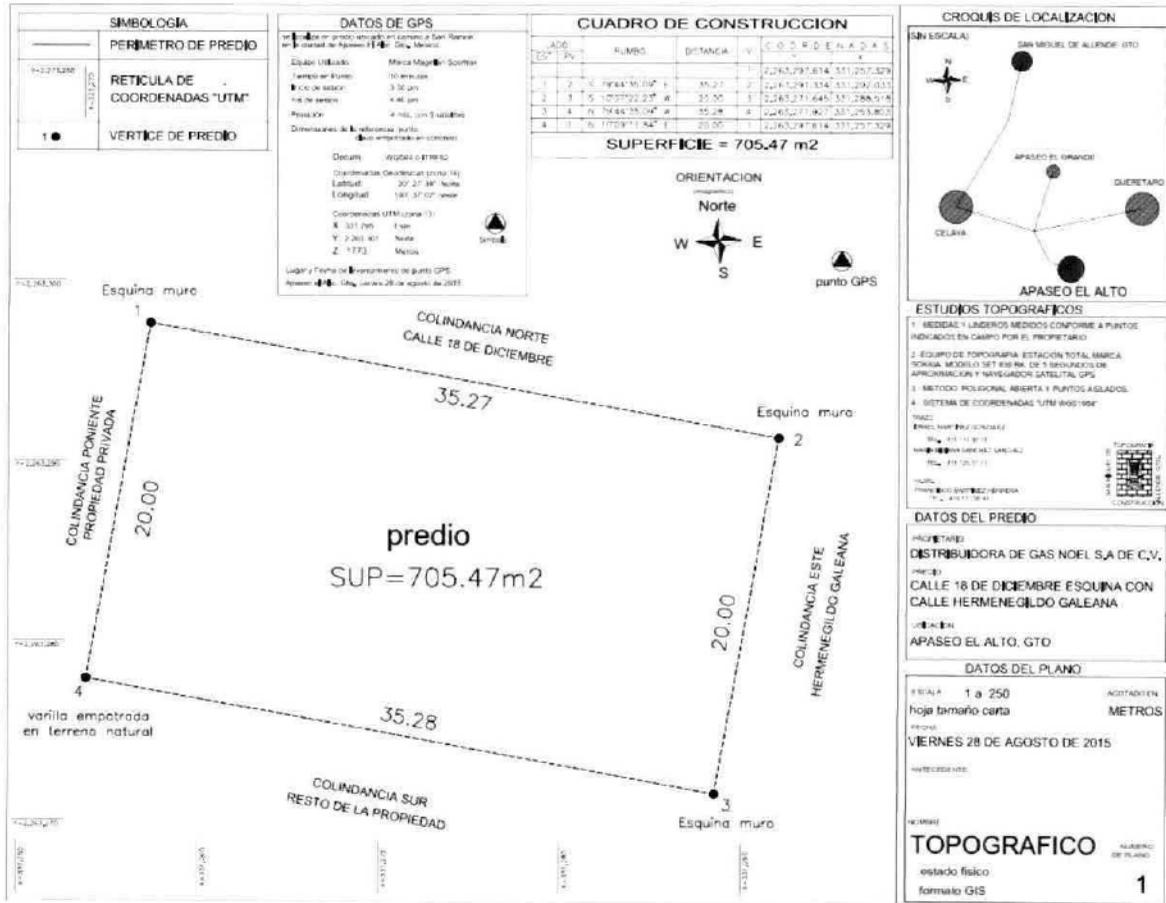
1. Plano de Levantamiento topográfico del proyecto.
